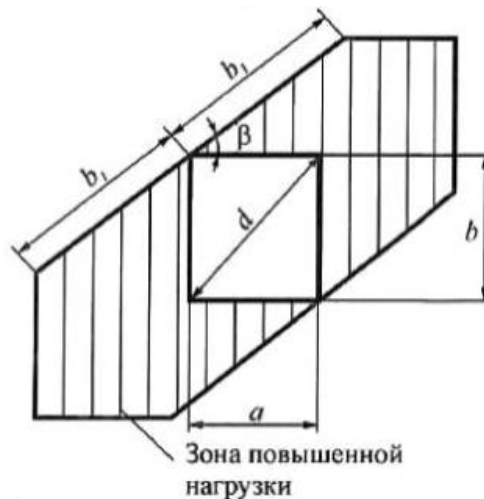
План расположения зоны повышенной нагрузки от снега
